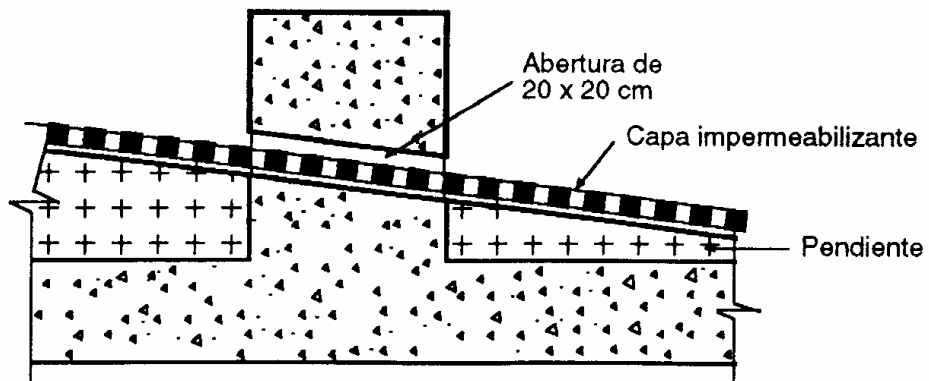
Impermeabilización en losas o placas con vigas invertidas
